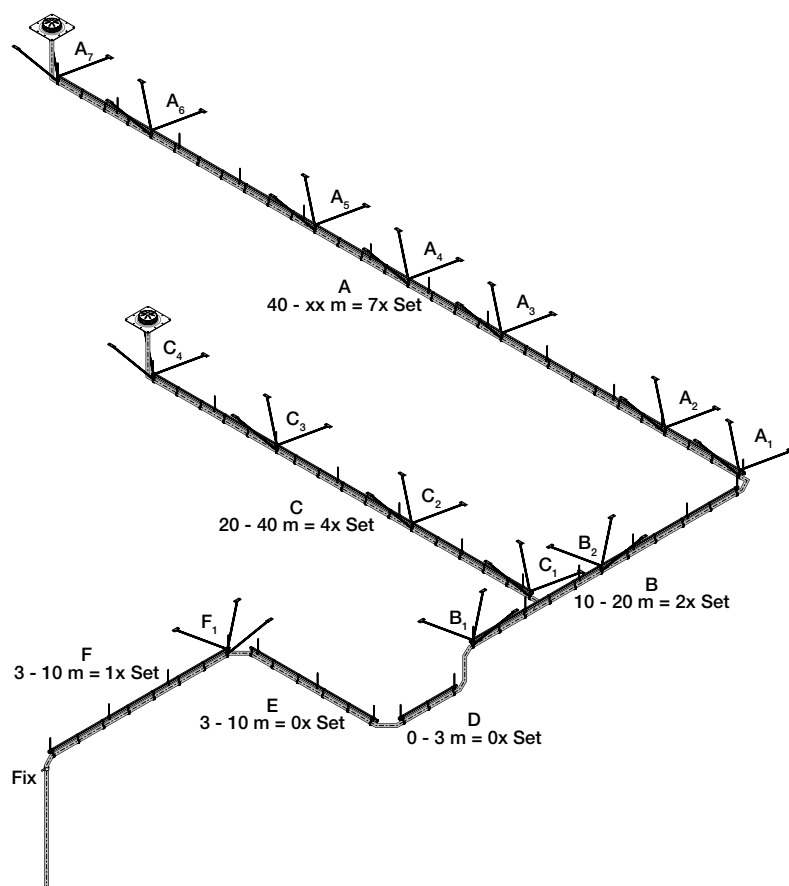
Размещение и количество дополнительных опор для трубопроводной системы с несколькими трубопроводными участками
